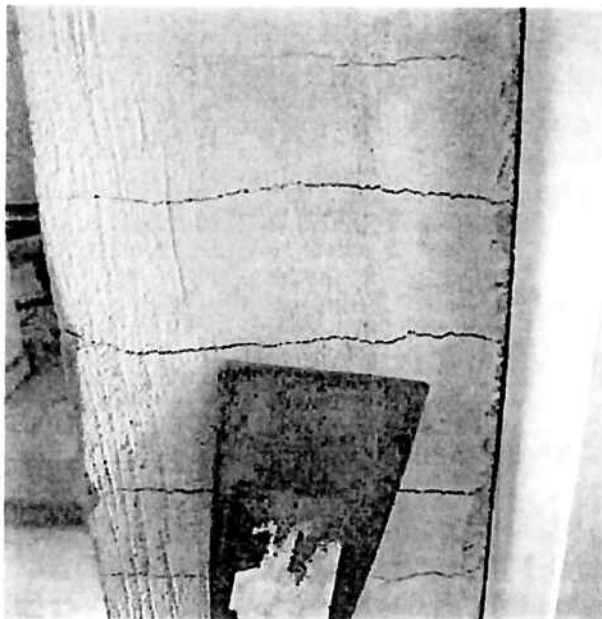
Fissuração do revestimento por falhas de execução – sarrafeamento antecipado
